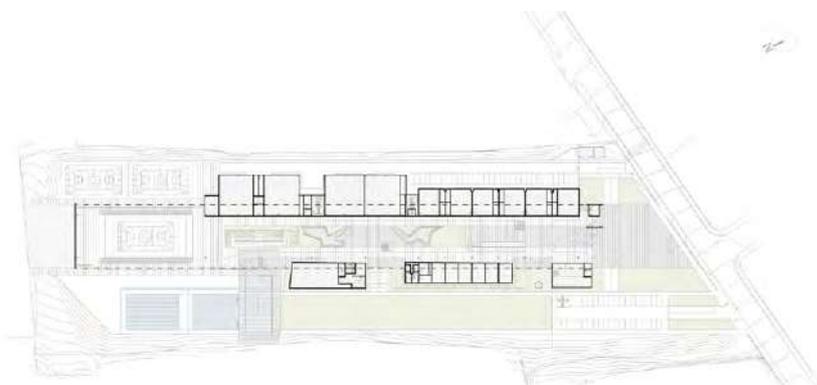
Planta do Pavimento Térreo, CEU Pimentas. Fonte: ArchDaily.
